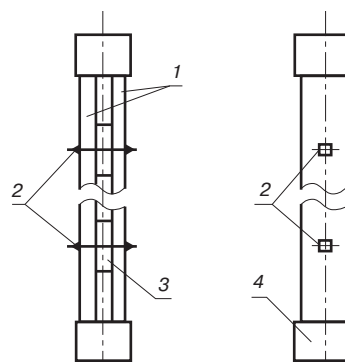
Колонны из линейных элементов: 1 – линейный элемент; 2 – соединительные болты; 3 – прокладки; 4 – оголовок
